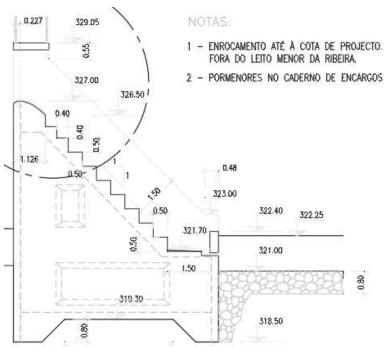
Corte transversal indicativa da soleira descarregadora de betão
